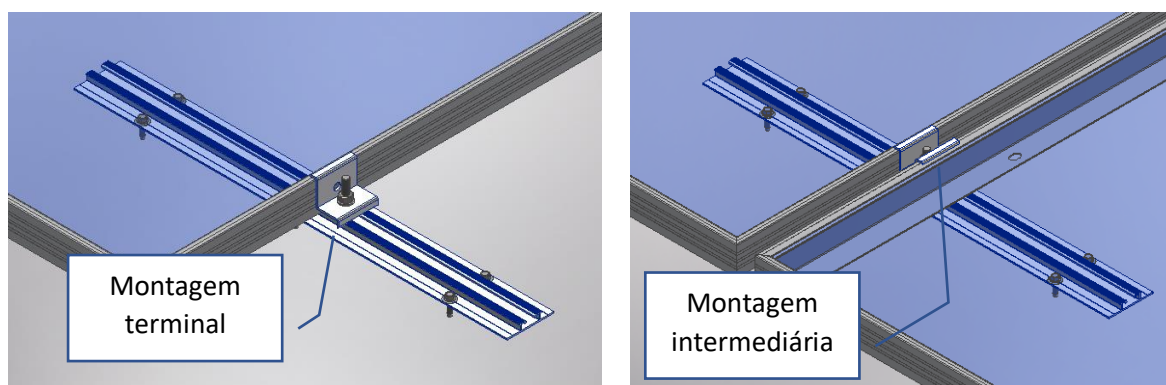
Detalhes de ancoragem do módulo fotovoltaico ao perfil PLP
